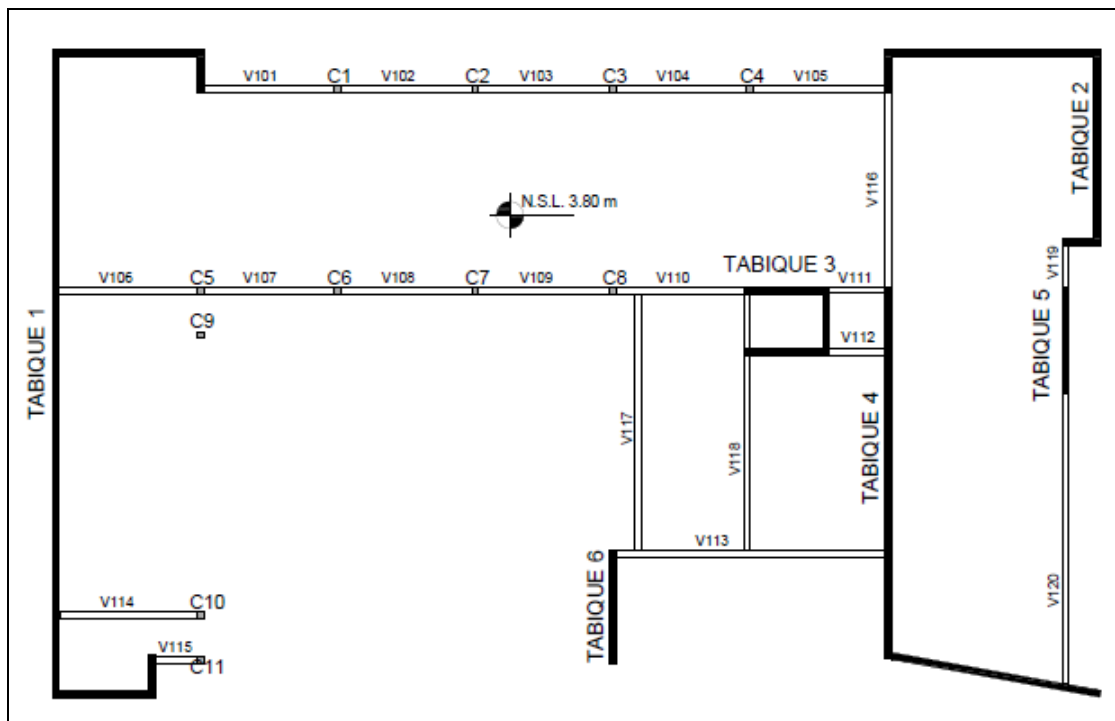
CORTE SECCIÓN A +3,80M
